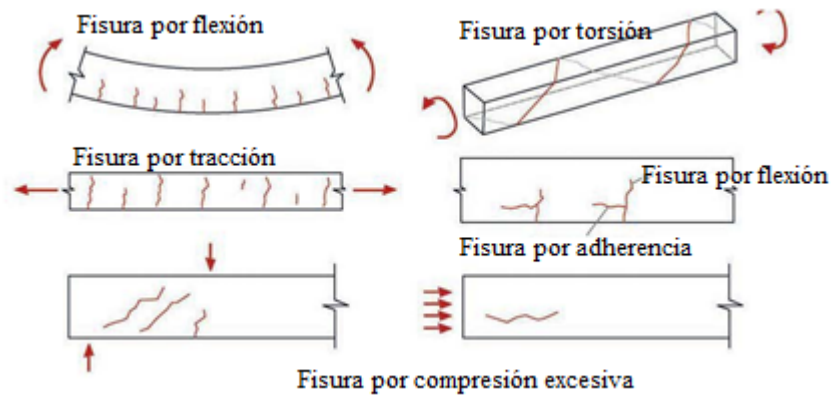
7 Fisuras debido a esfuerzos estructurales
